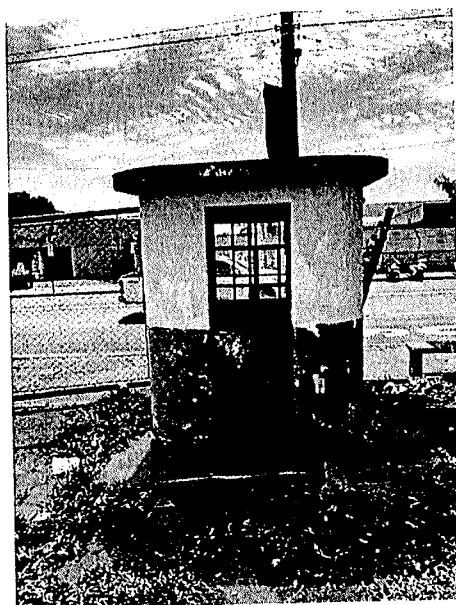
Guarita em alvenaria, com cobertura plana em concreto com acabamento de reboco e pintura. O fechamento vertical inclui uma porta de chapa metálica.
